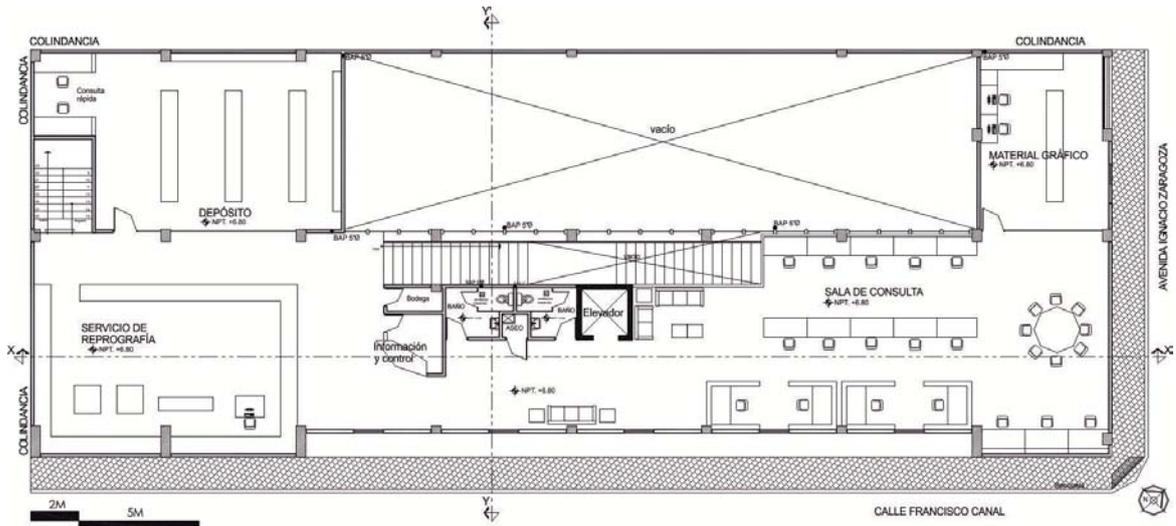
Proyecto ejecutivo: Planta arquitectónica segundo nivel.
